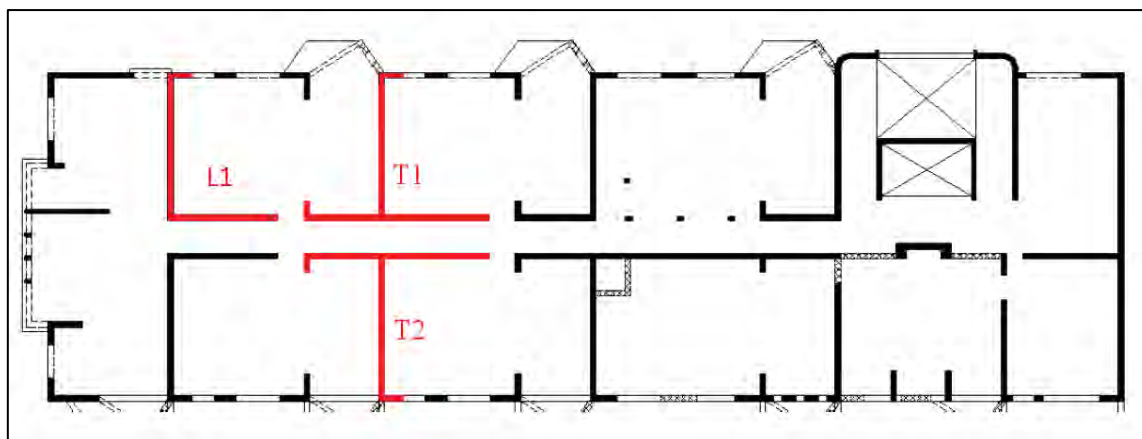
Planta típica del edificio Alto Río ubicado en Concepción
